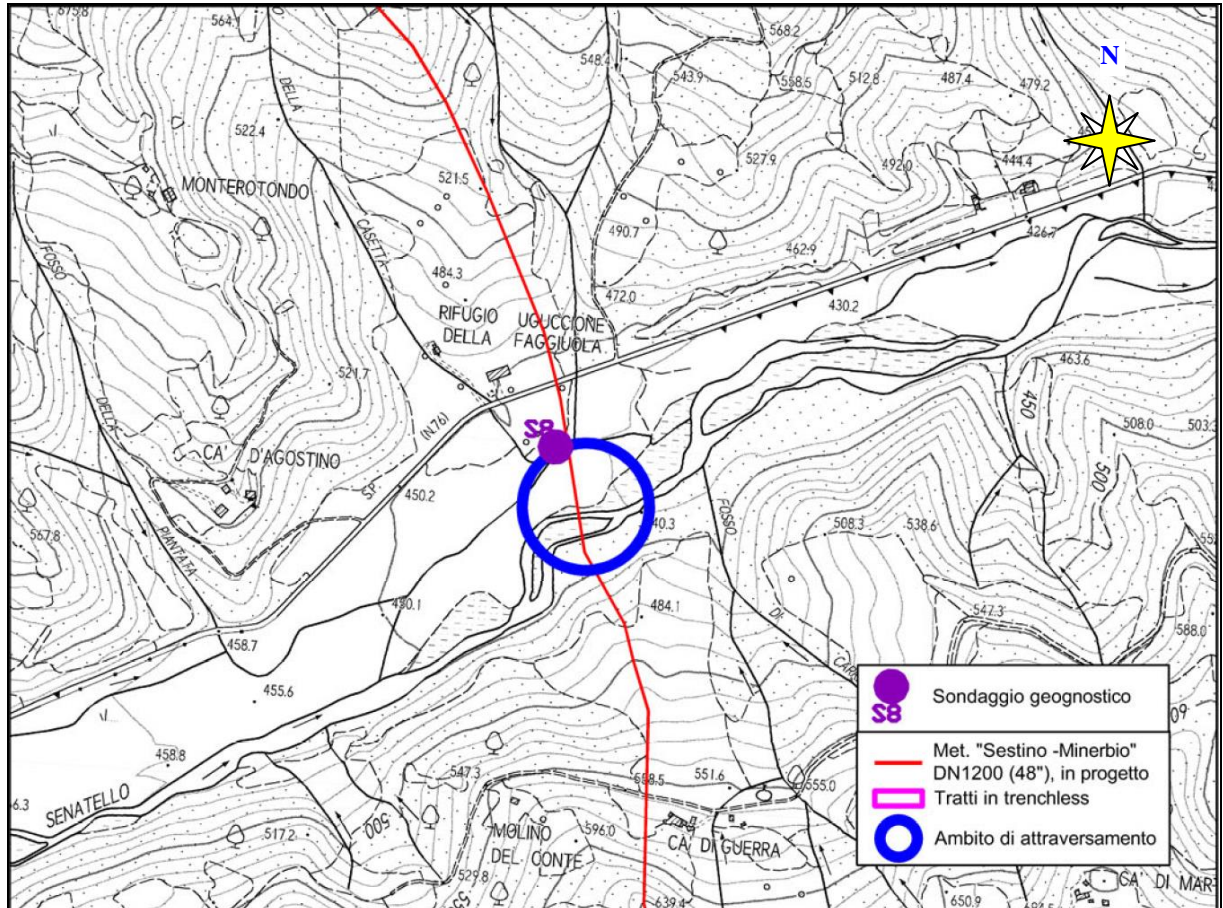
/A: Planimetria in scala 1:10.000, con ubicazione del sondaggio di interesse
